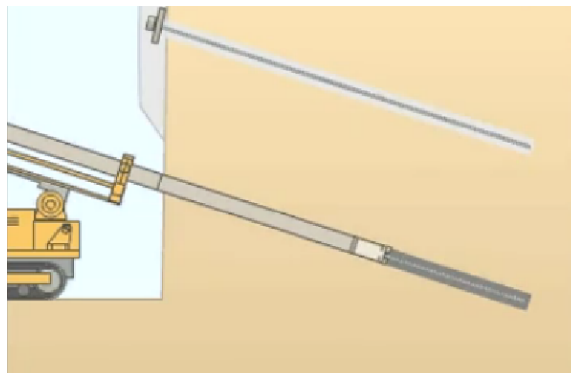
Execució Soil Nailing. Injecció de formigó (Font: www.youtube.com)
